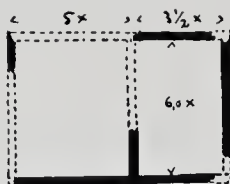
Grundriß einer Hausruine aus Kohaito. (Ruine 2.)
